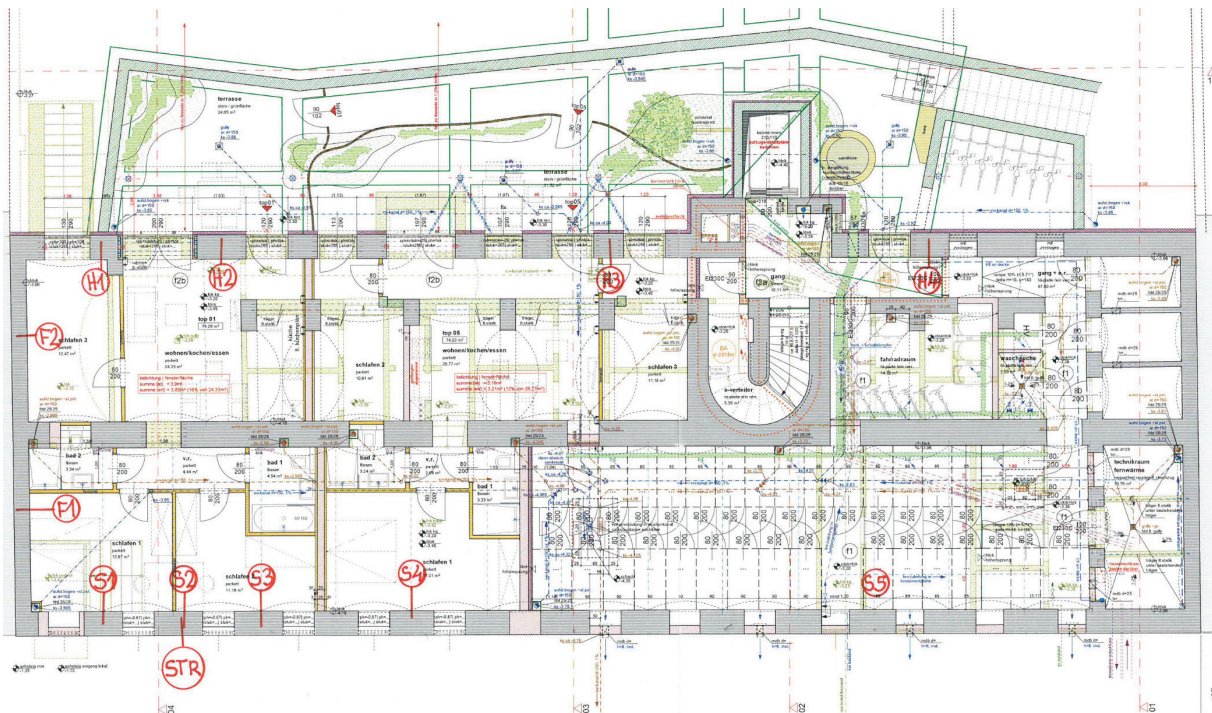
Grundriss des Kellers Neilreichgasse 3-5 mit Markierungen der Probeentnahmestellen
